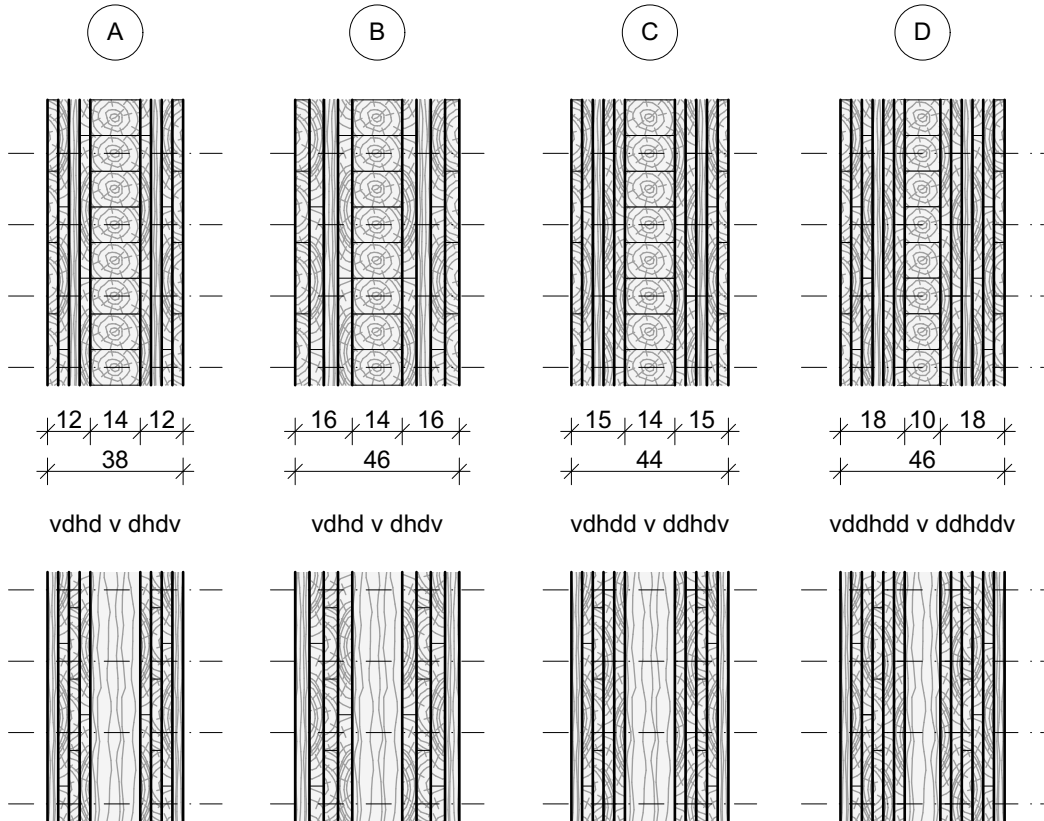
4 mögliche Wandaufbauten - Horizontal- und Vertikalschnitt M 1:20
